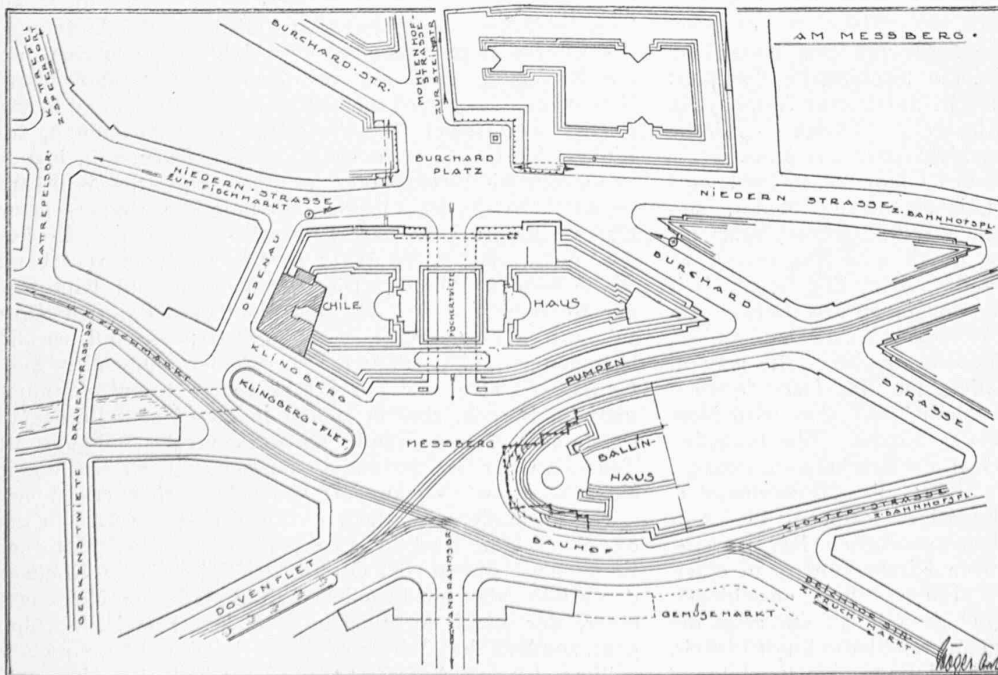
Süd-Fassade am Messberg; Abb. 2 Geschosse-Grundriss 1:1000; Abb. 3 Lageplan (in Draufsicht) 1:2500. Das benachbarte „Ballinhaus“ wurde, abweichend von Högers Planung, nach der gestrichelten, unorganischen Flucht errichtet.
